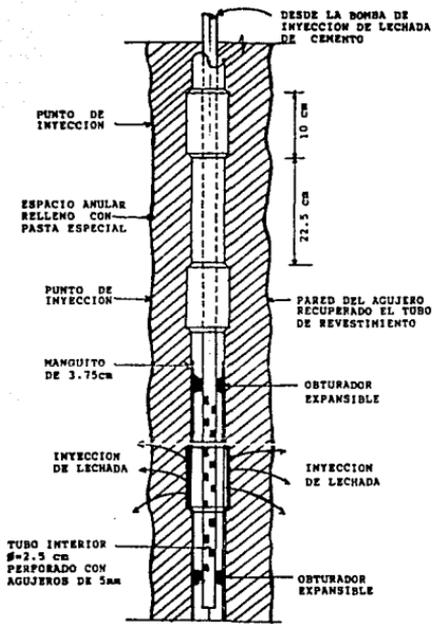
TUBO SOLTANCHE DE INYECCION DE LECHADA
